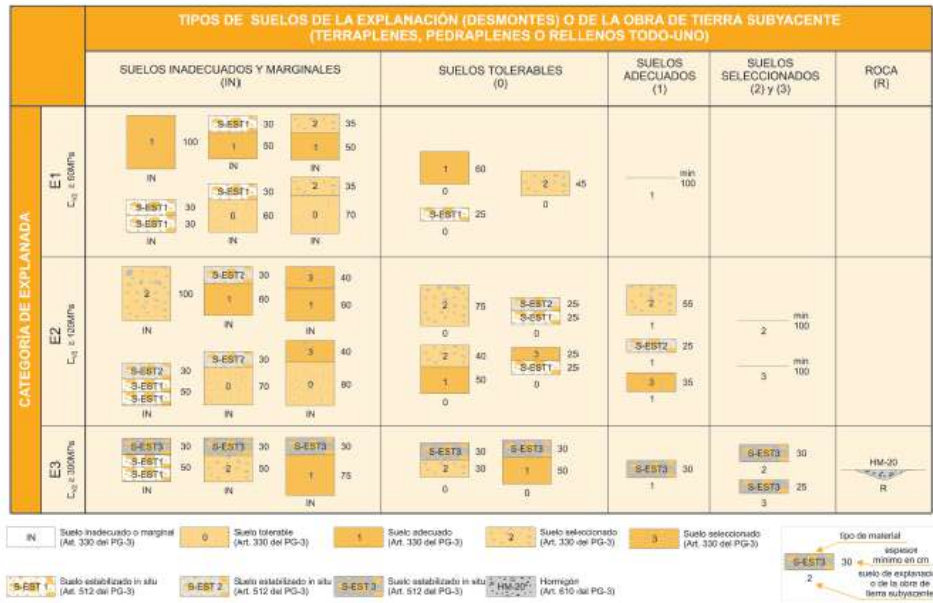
FORMACIÓN DE LA EXPLANADA
